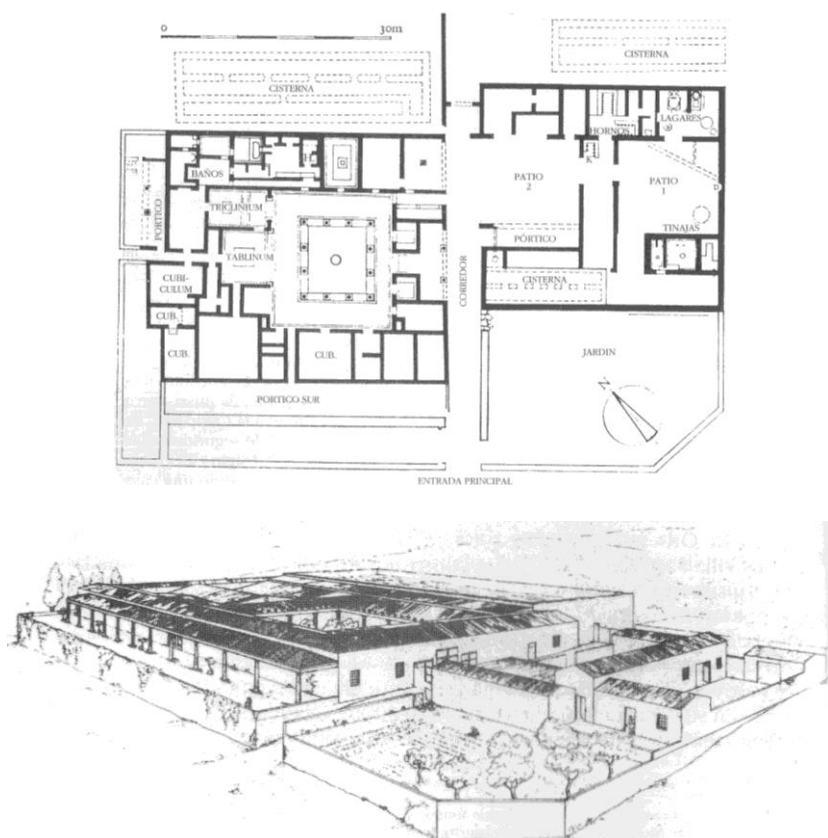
Planta Villa San Rocco, 75 - 50 a. C. Imagen 642. Vista lado sur oeste Villa San Rocco. Fuente: Libro La Villa. Forma e Ideología de las Casas de Campo, James S. Ackerman.
